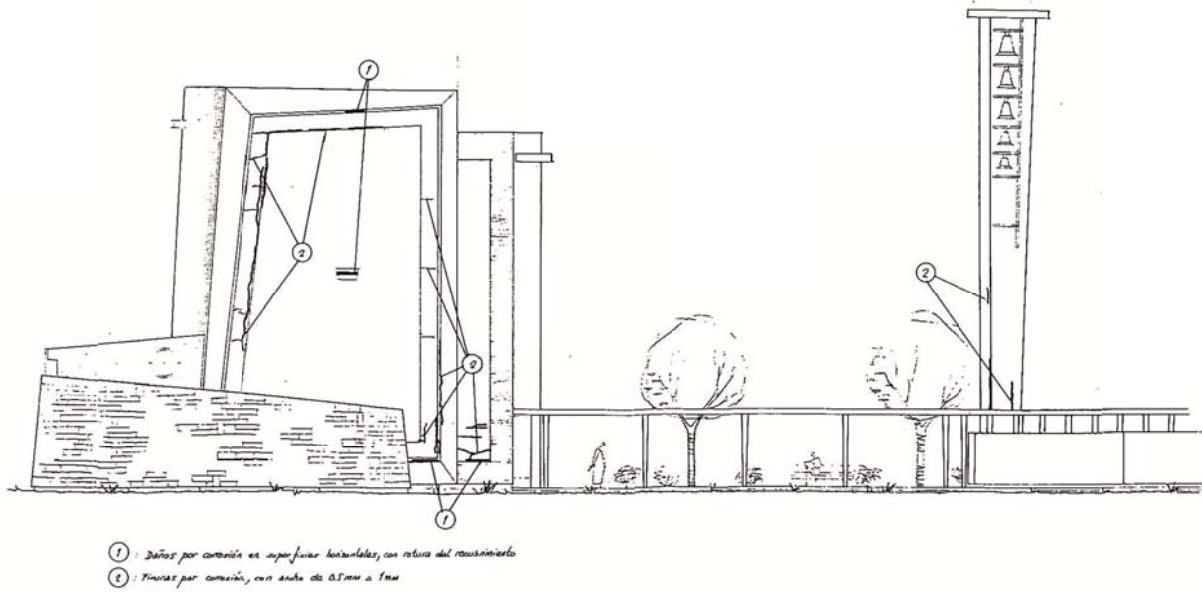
Croquis daños Fachada Este (Fernández, J. 1999)
